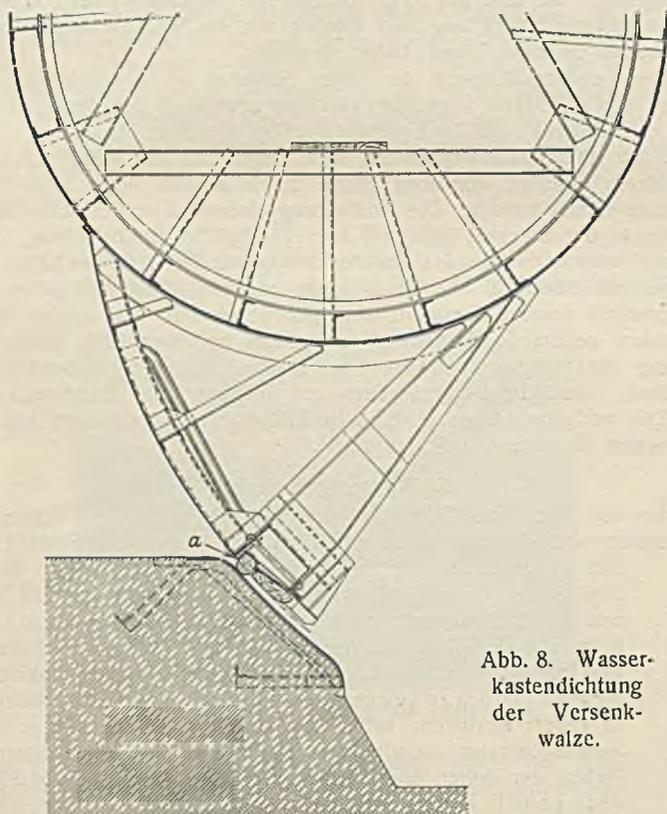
Wasser-kastendichtung der Versenkwalze.
